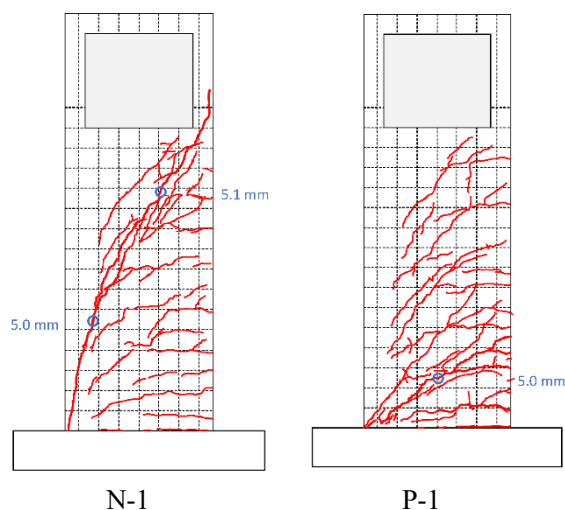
载荷①のピーク耐力確認時のひび割れ状況
